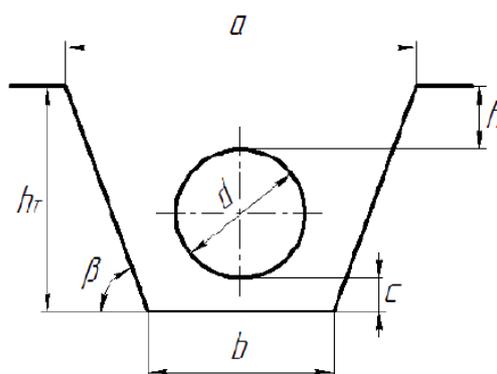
Поперечный профиль траншеи трубопровода
